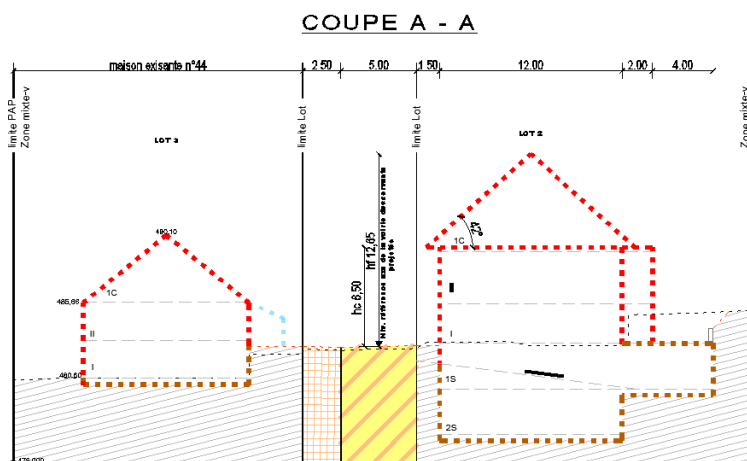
Coupe transversale des bâtiments (Source : BEST)
